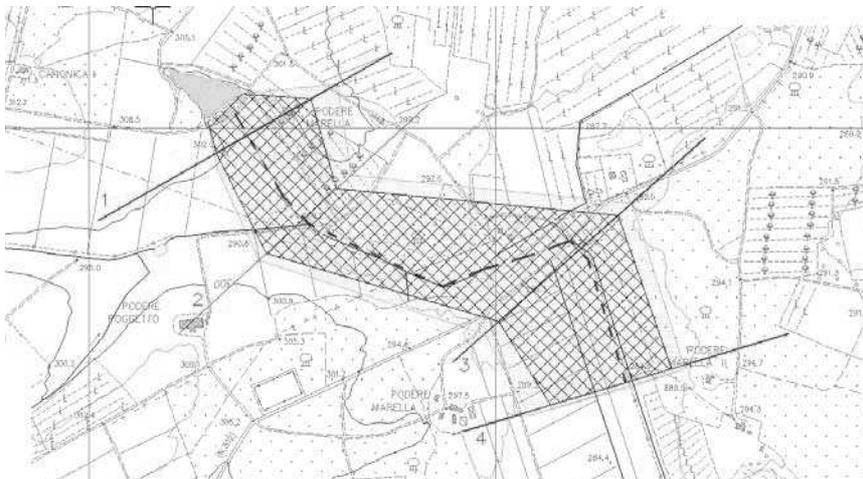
Rappresentazione planimetrica dell'area da indagare per la determinazione del rischio indotto
